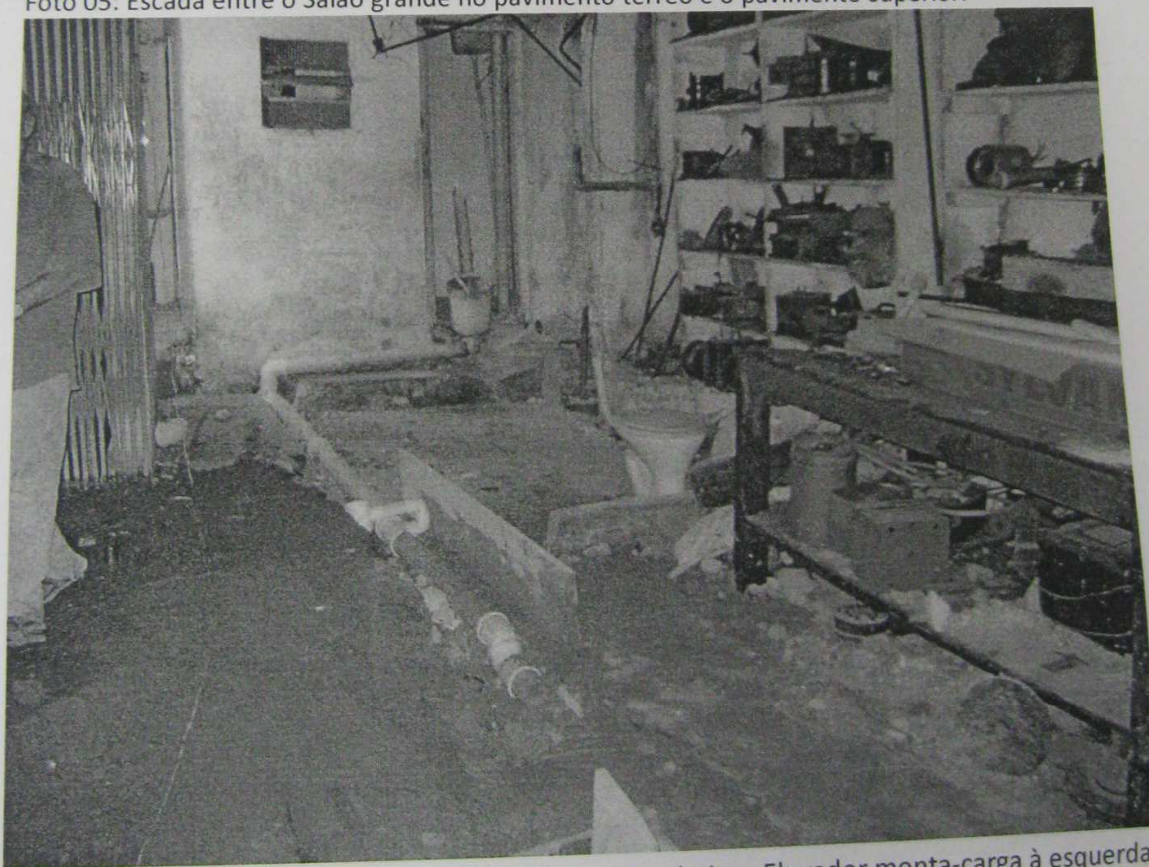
Salão nos fundos do pavimento térreo e banheiro. Elevador monta-carga à esquerda.
